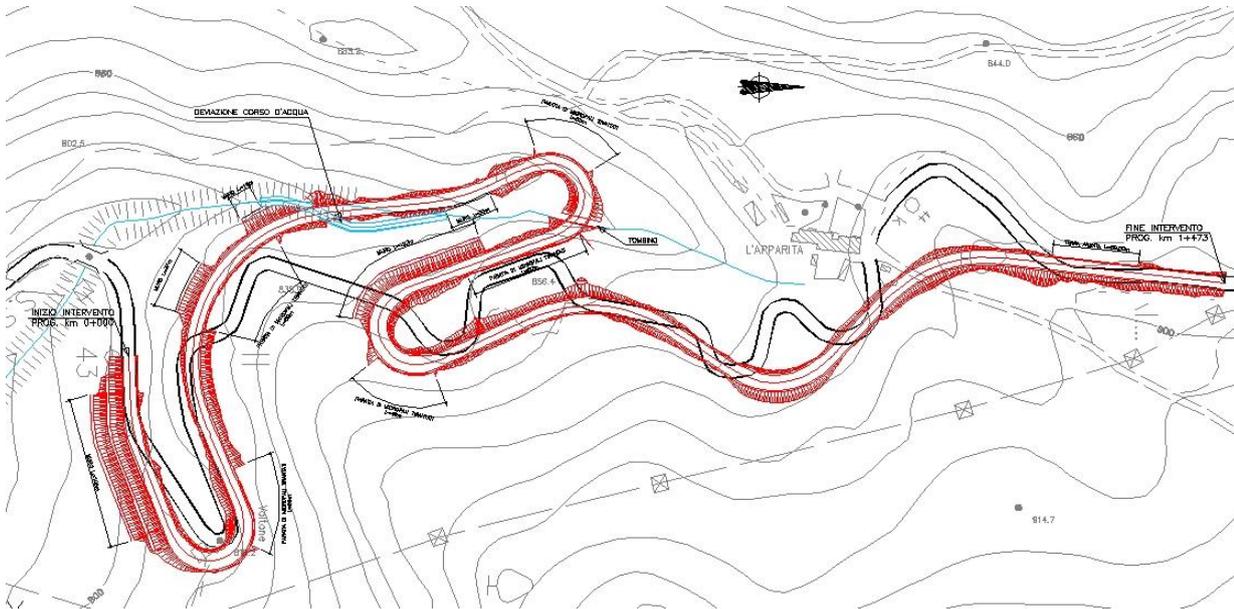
Stralcio planimetrico riqualifica SP116
